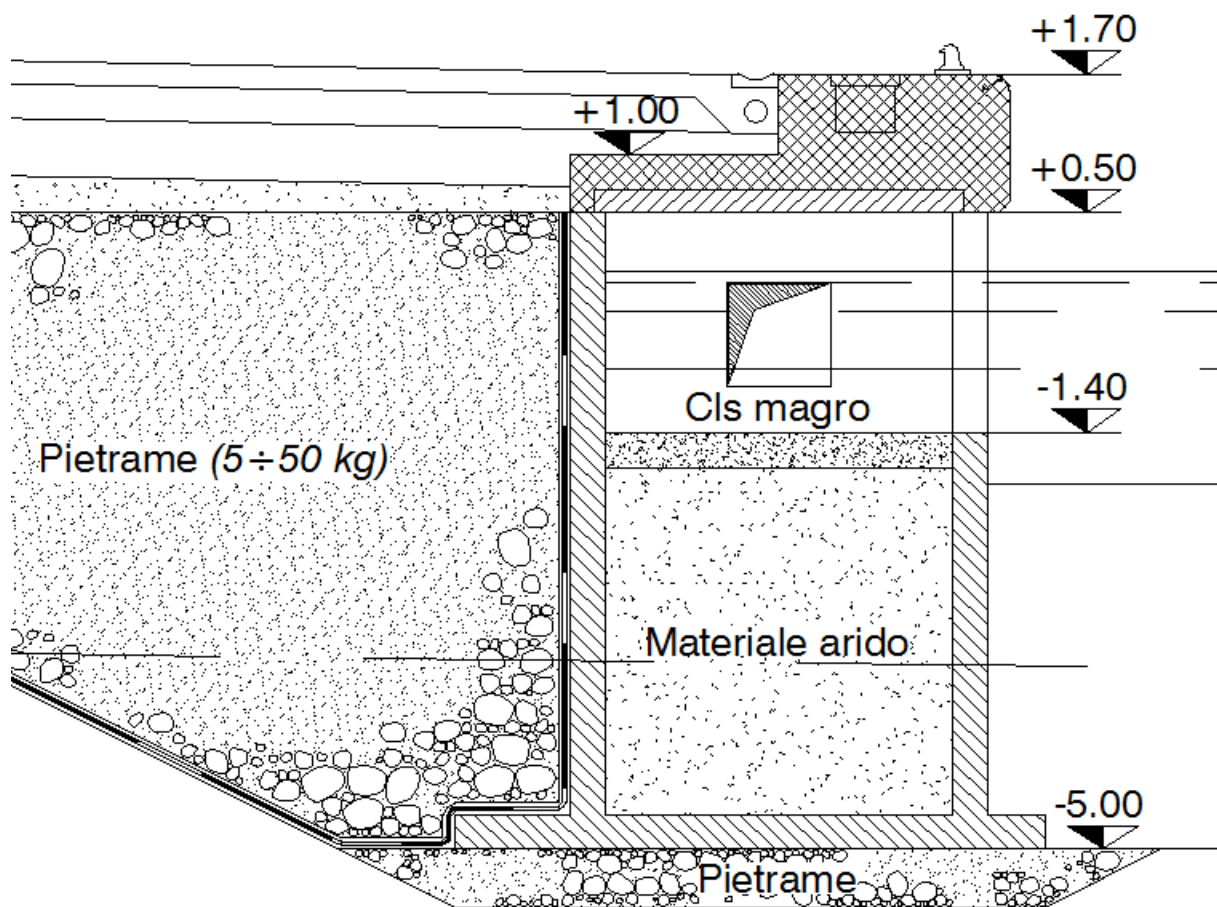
Schema geometrico della sezione G – G dell'area cantieri navali di Capo d'Anzio (Scala 1:100).
